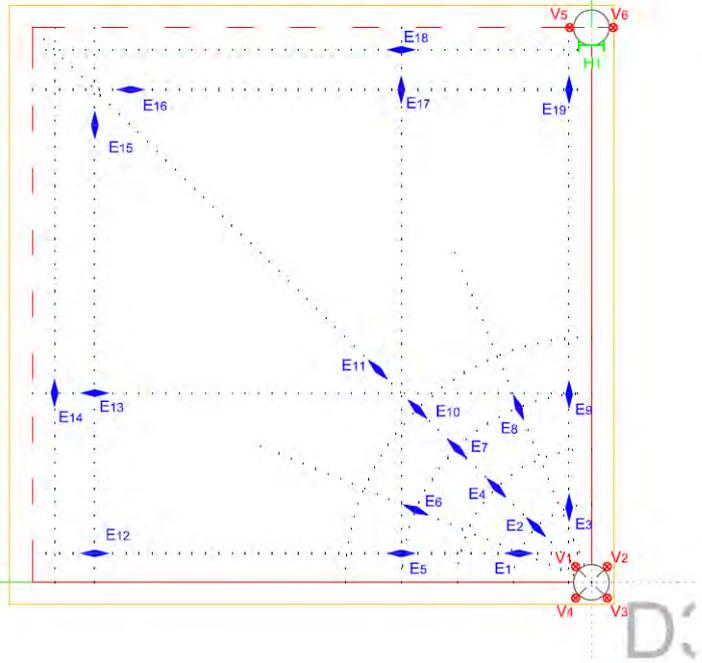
Plan général d'instrumentation de la chaussée rigide
